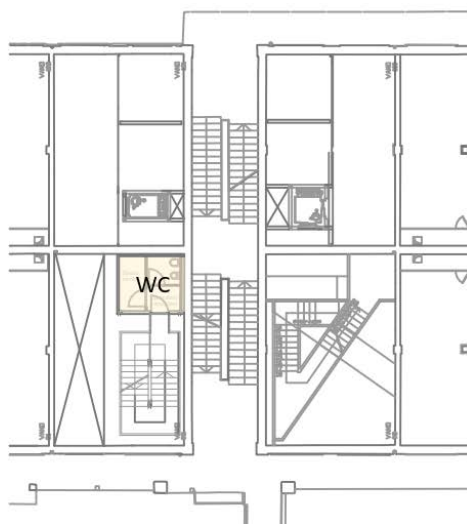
Pianta piano ammezzato: destinazione d'uso ambienti principali
